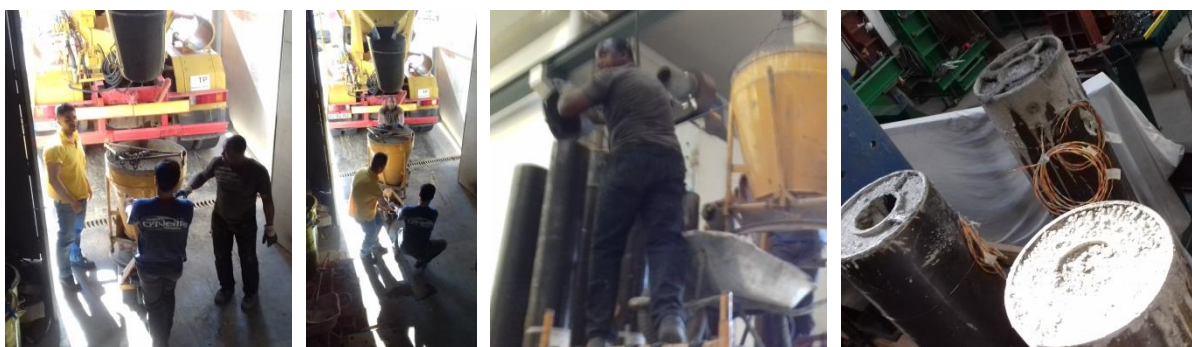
Preenchimento dos pilares com o concreto usinado
